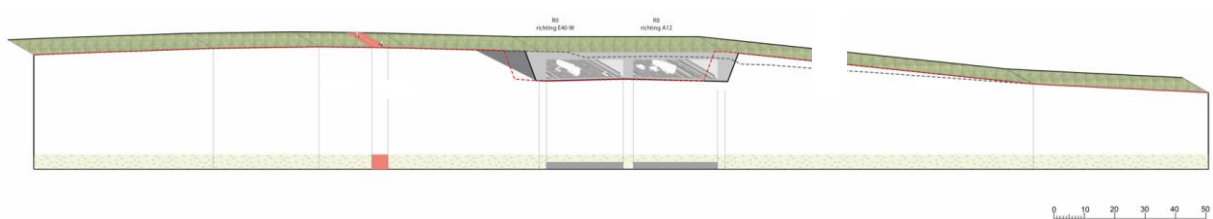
Coupe transversale AA - G1 LPa\_LB\_1
